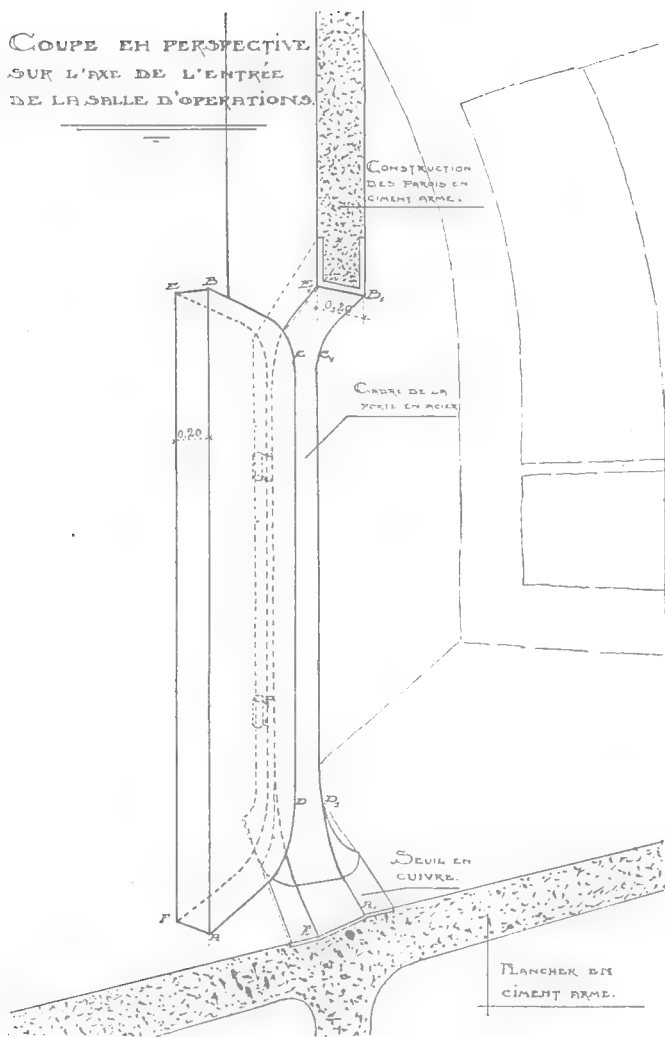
Coupe sur la salle d'opérations, montrant les détails de la porte.
